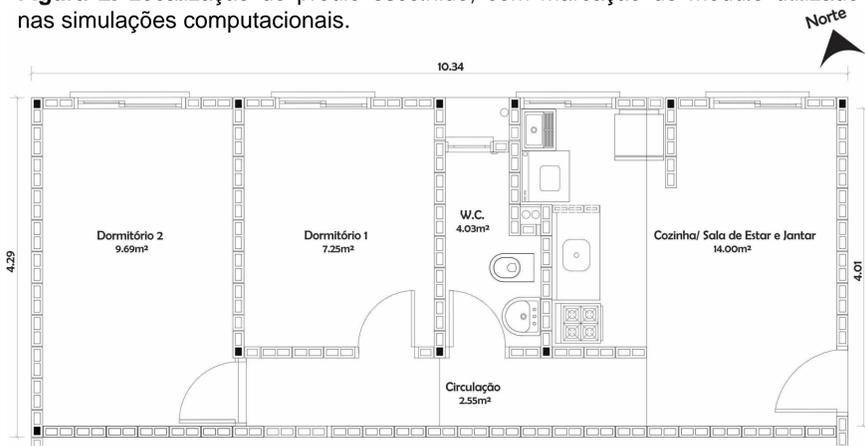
Planta baixa do módulo de apartamento utilizado como estudo de caso.
